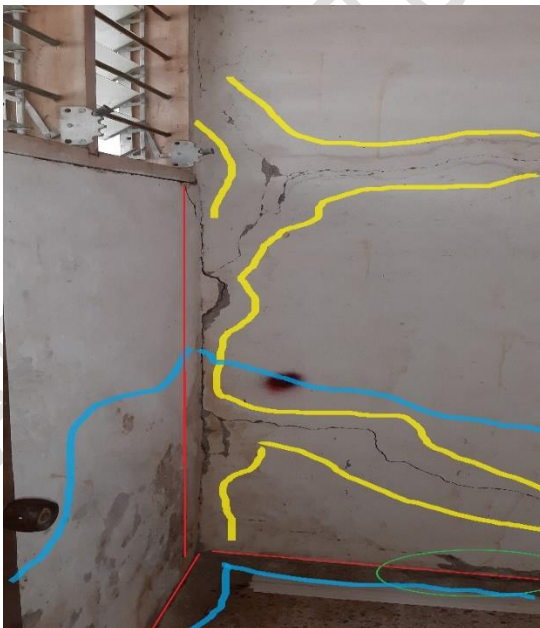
Grieta diagonal en muro, con desprendimientos de enlucidos y desplazamiento del plano frontal.
